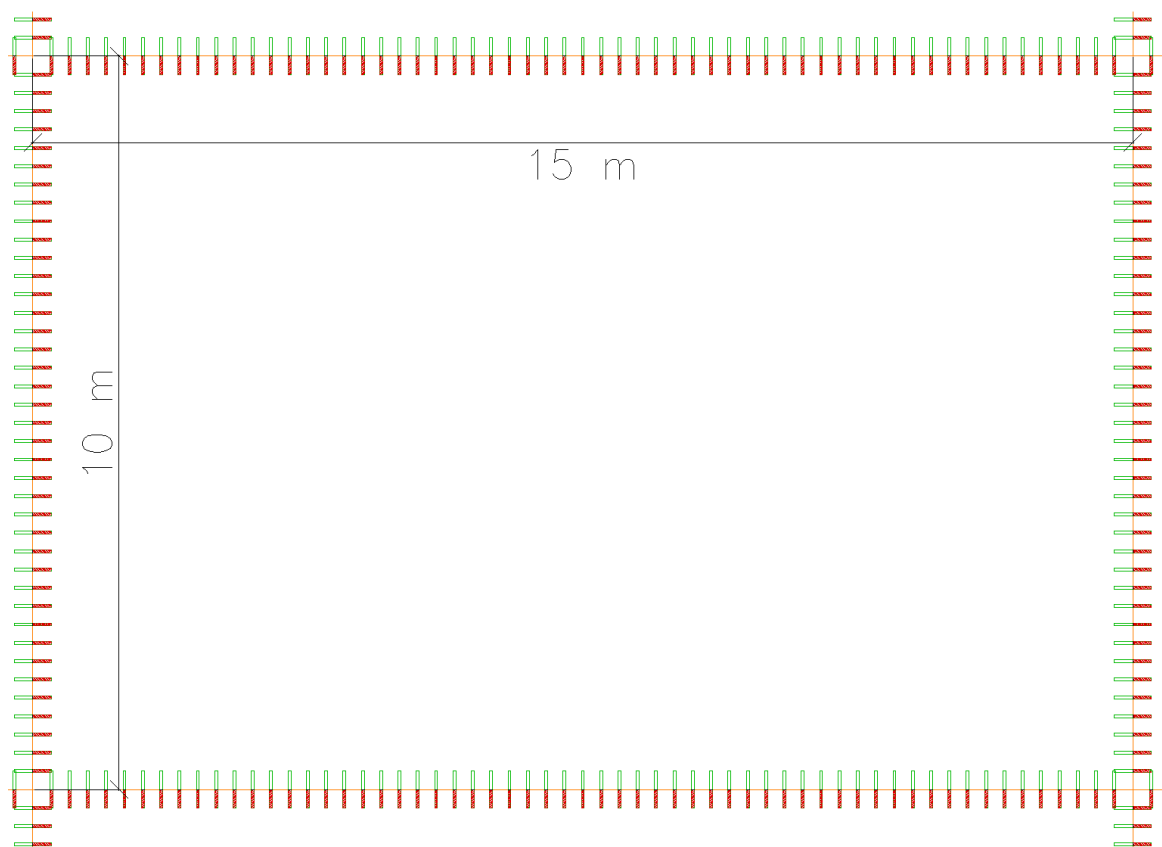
Dimensões da placa de concreto. Fonte: Software AutoCAD
